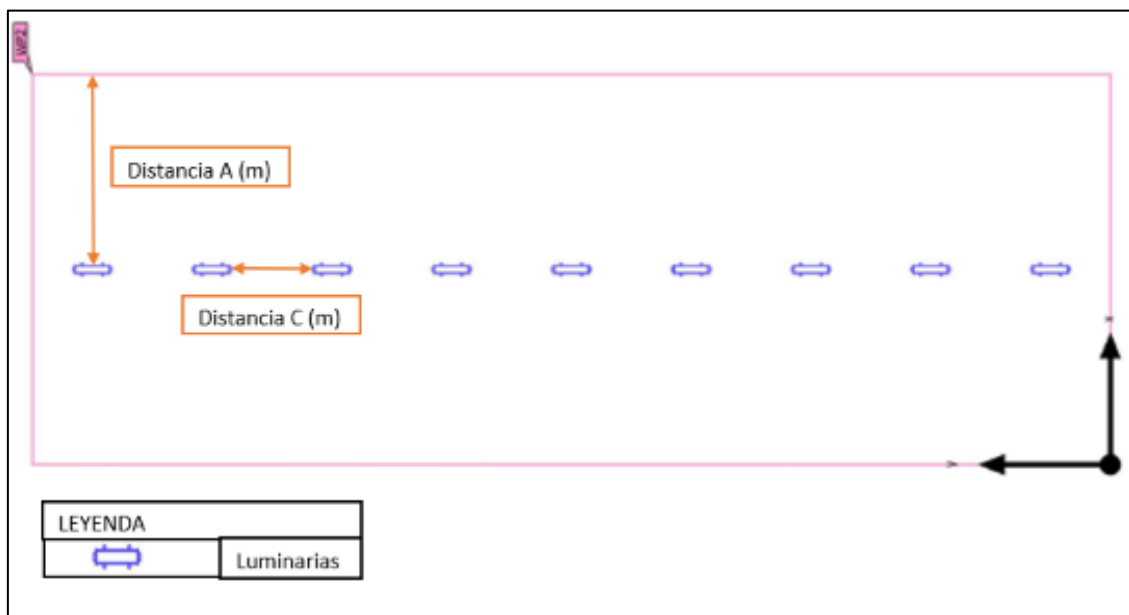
Vista de planta de los detalles de distancias entre luminarias
